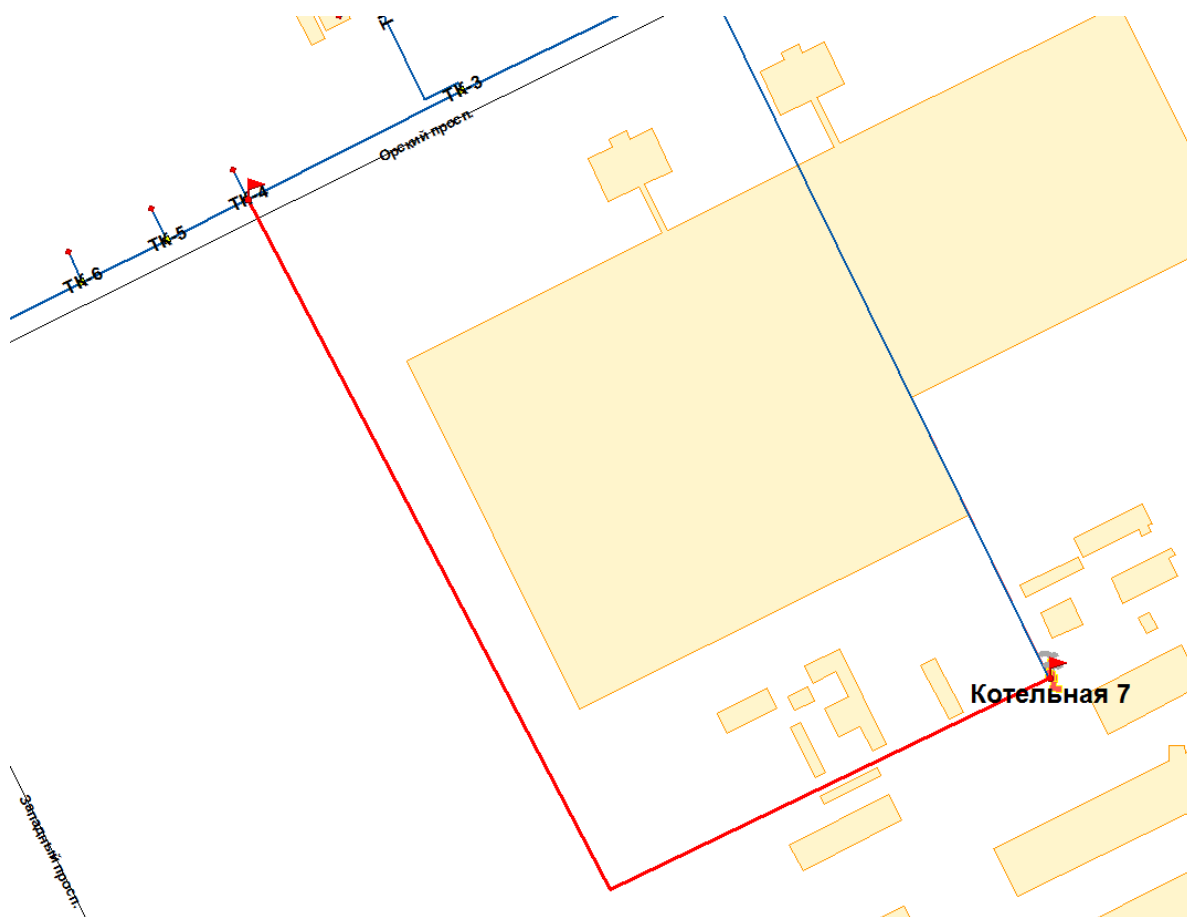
Схема прокладки нового трубопровода от котельной № 7
